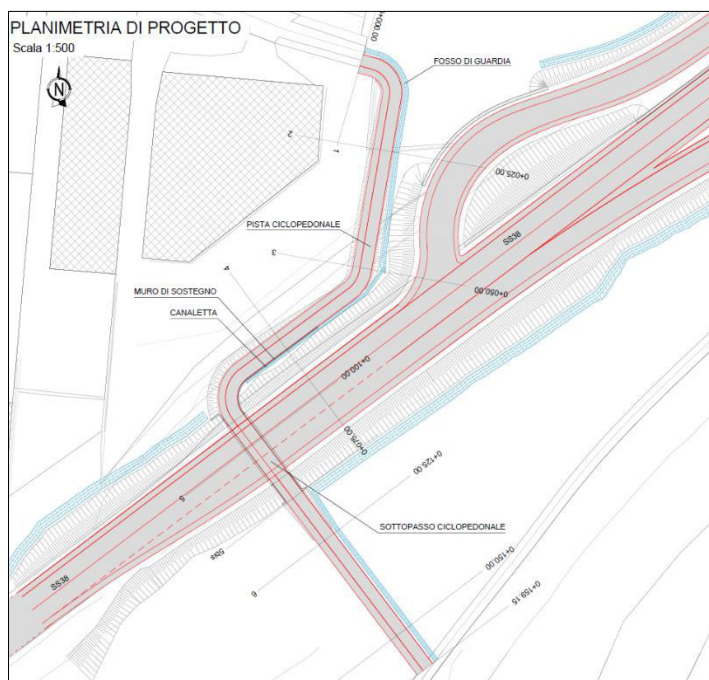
estratto planimetria di progetto pista ciclopedonale.
